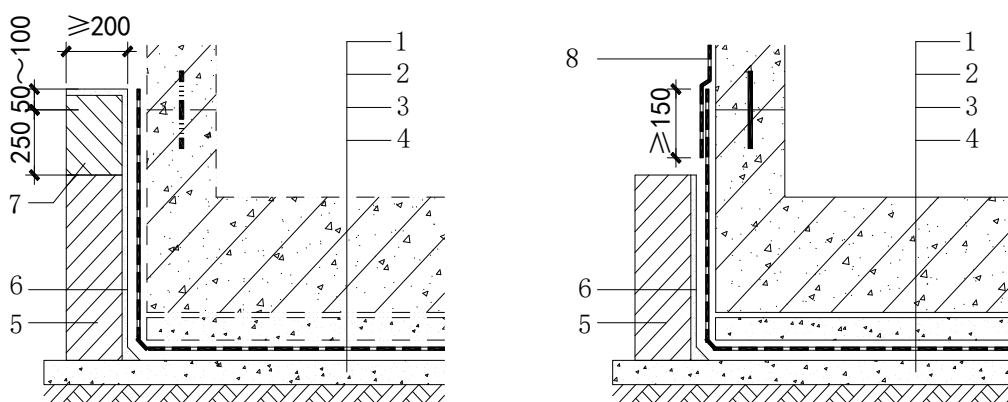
底板卷材防水层甩槎构造 图 5.2.16-2 底板卷材防水层接槎构造
